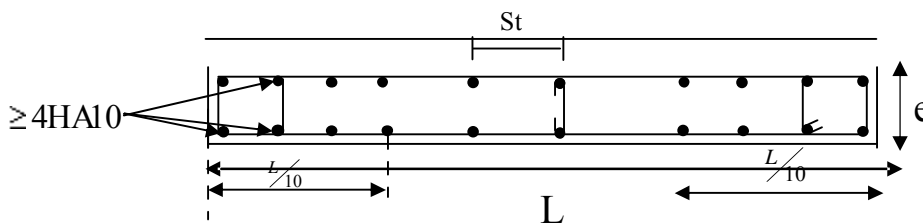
Disposition des armatures verticales dans les voiles.
